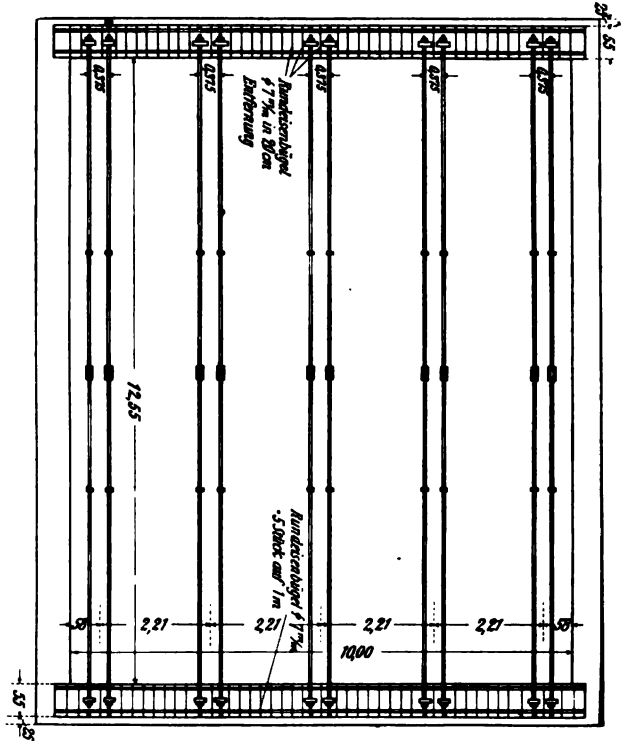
Grundriß des Daches (s. Abb. 245 bis 248).
